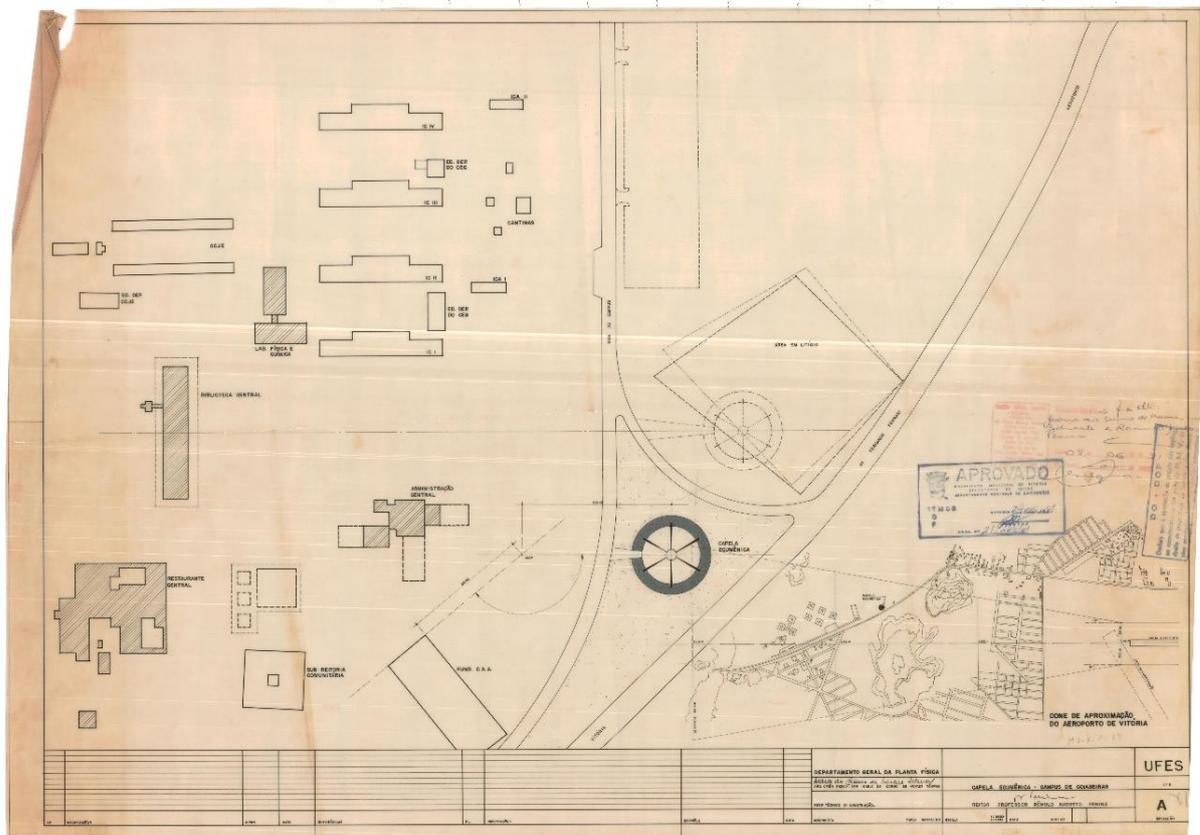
Prancha técnica planta de situação Capela Ecumênica UFES.
